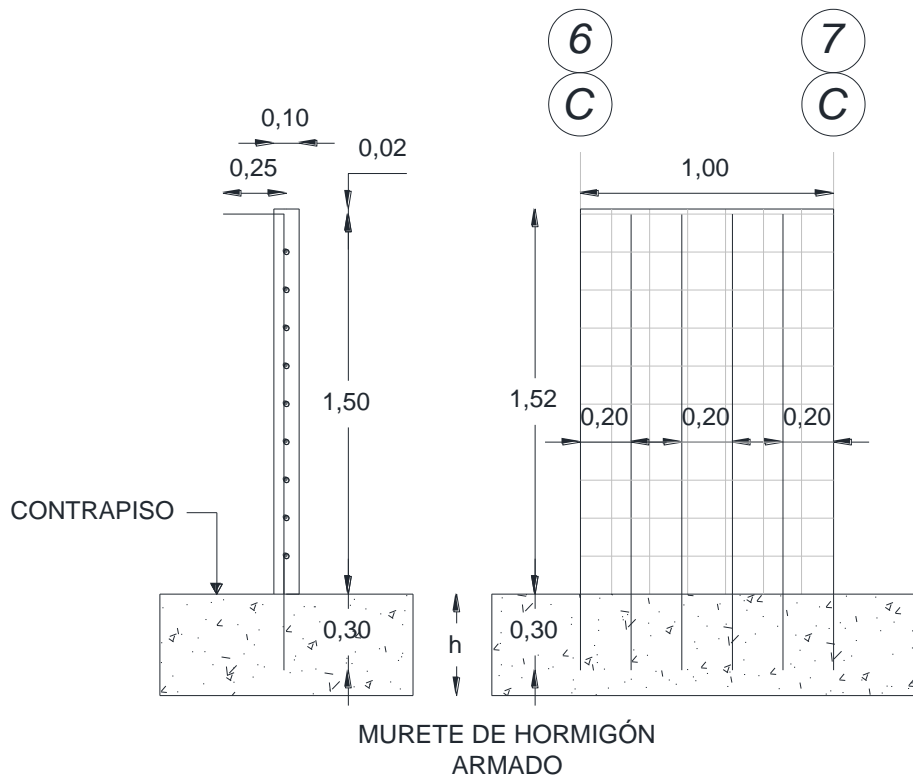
Murete de Hormigón Armado – Reforzamiento Estructural.
